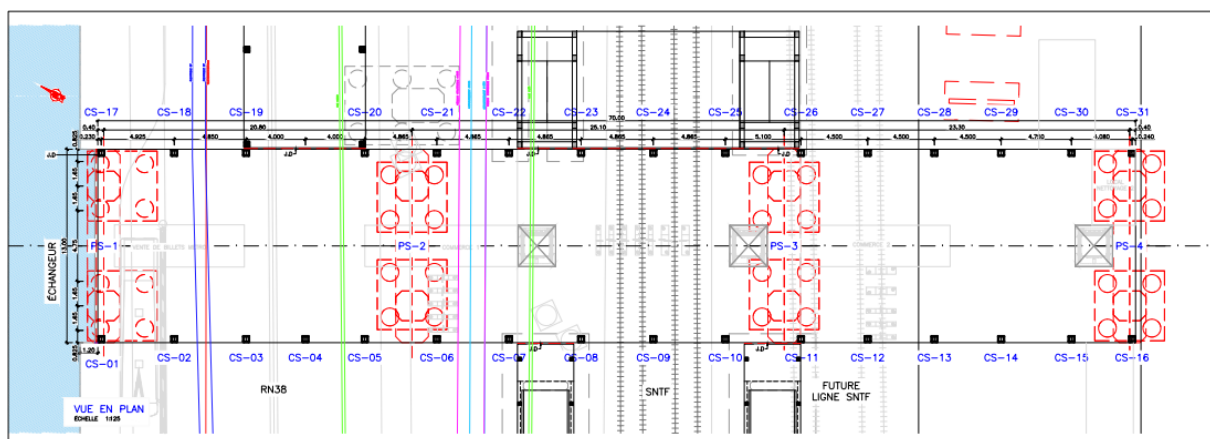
Vue en plan du plan de la passerelle SNTF M29 Ain Naadja Gare
